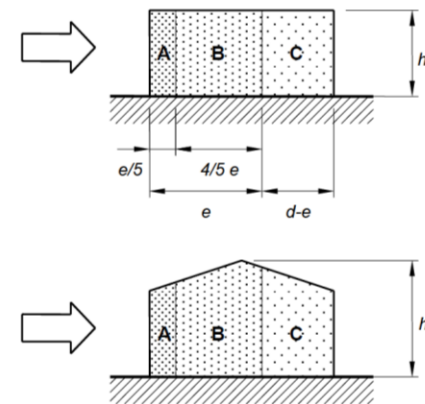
Suddivisione delle pareti verticali di edifici a pianta rettangolare in zone di uguale pressione (prospetto).
